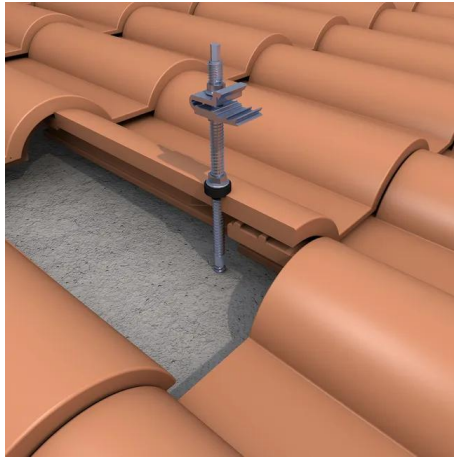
Perfuração diretamente sobre a telha até à placa de betão [49]
